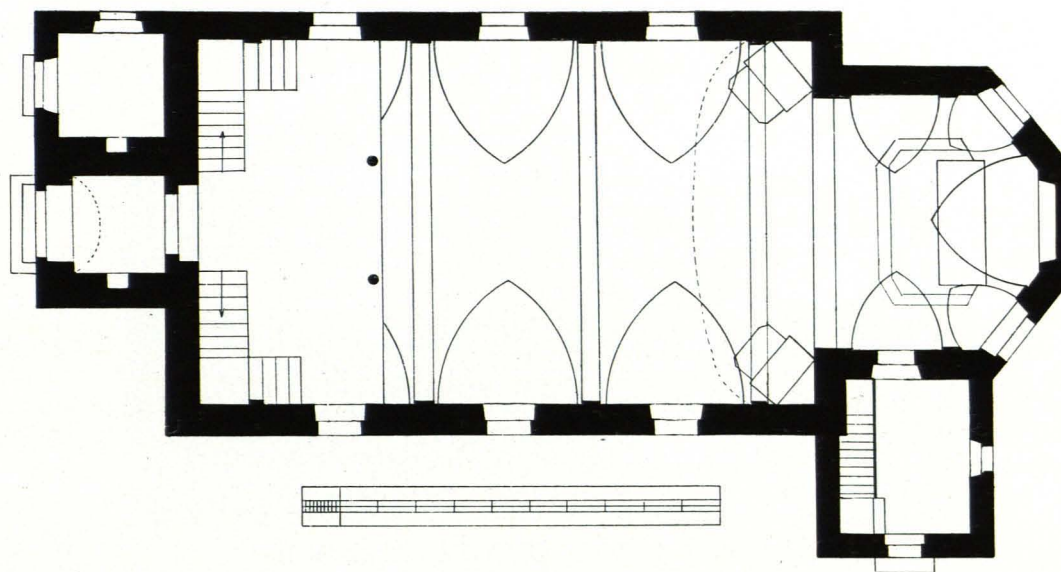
Plainfeld. Pfarrkirche, Grundriß 1:200 (S. 444)
